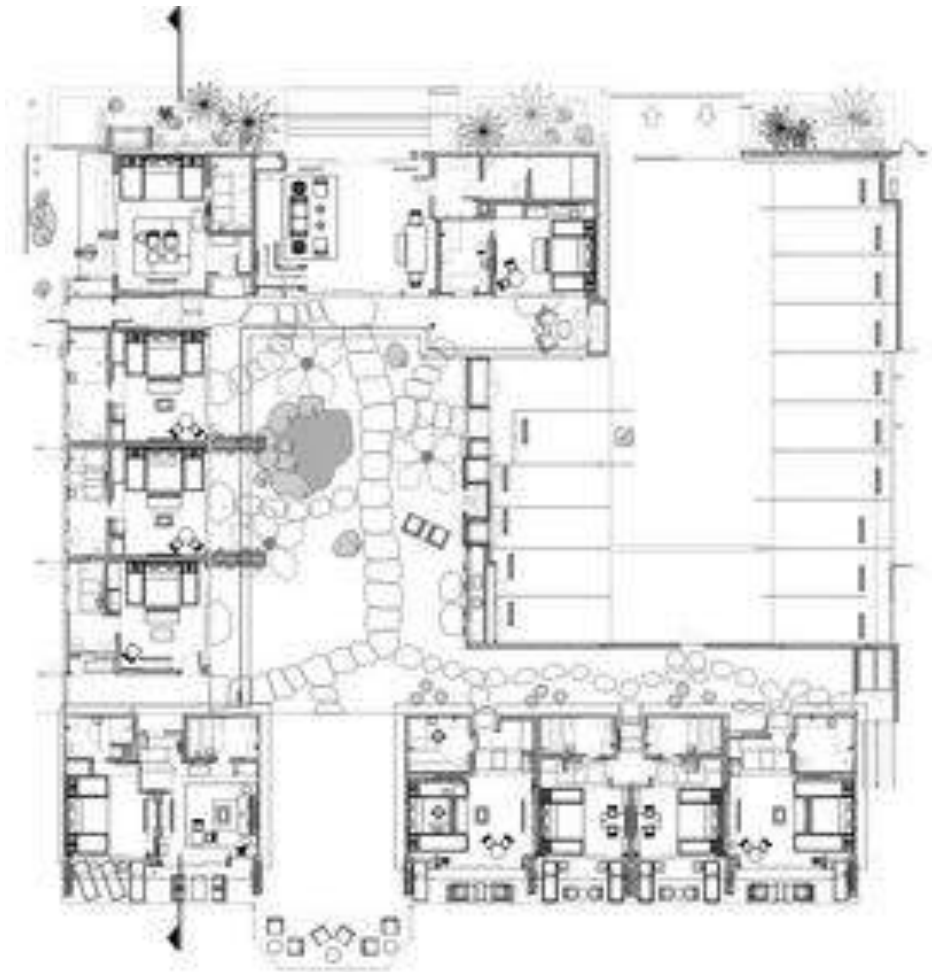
Planta baja de Nobu Ryokan Hotel
